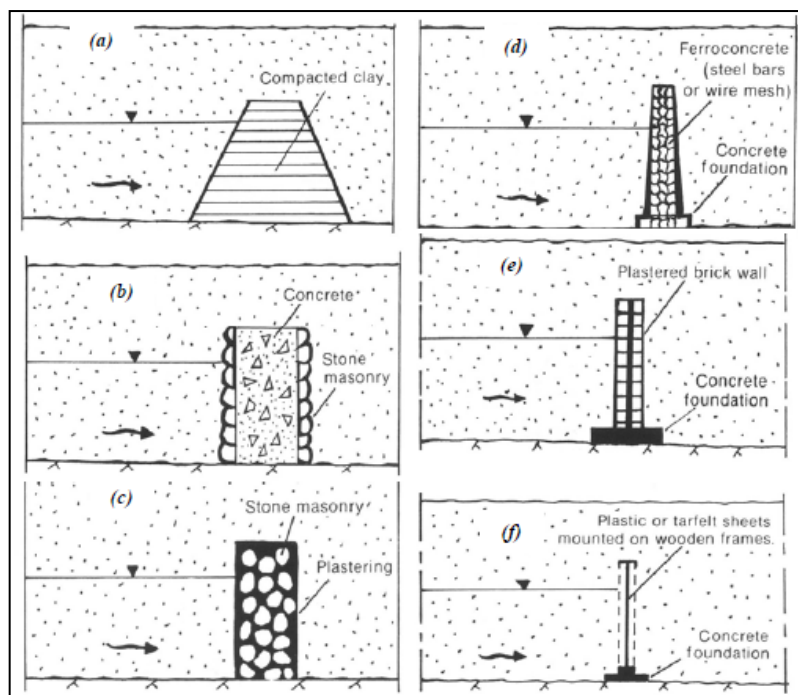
Tipos de construções de barragens subterrâneas a) Parede compactada de argila b) Parede de betão, c) Alvenaria de pedra, d) Betão reforçado, e) Parede de tijolo plastificada, f) Parede de madeira coberta por filme de plástico (Nilsson, 1988)
